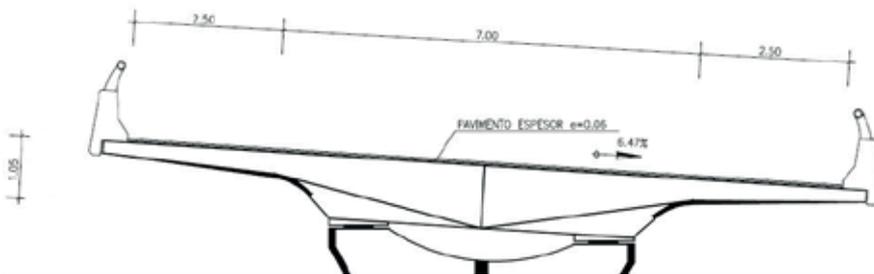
Sección tipo del tablero de la estructura de la carretera SG-20
